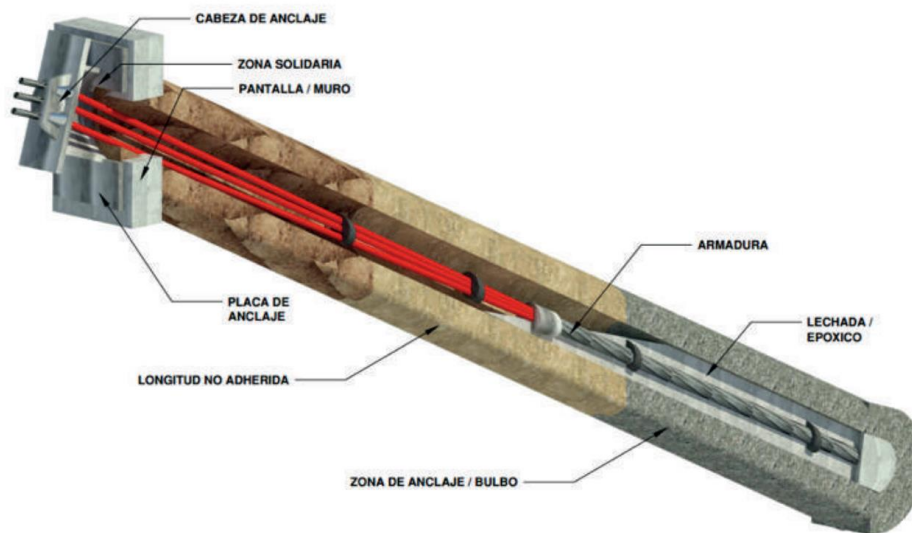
, anclaje activo. Fuente: (TOXEMENT, 2020)
